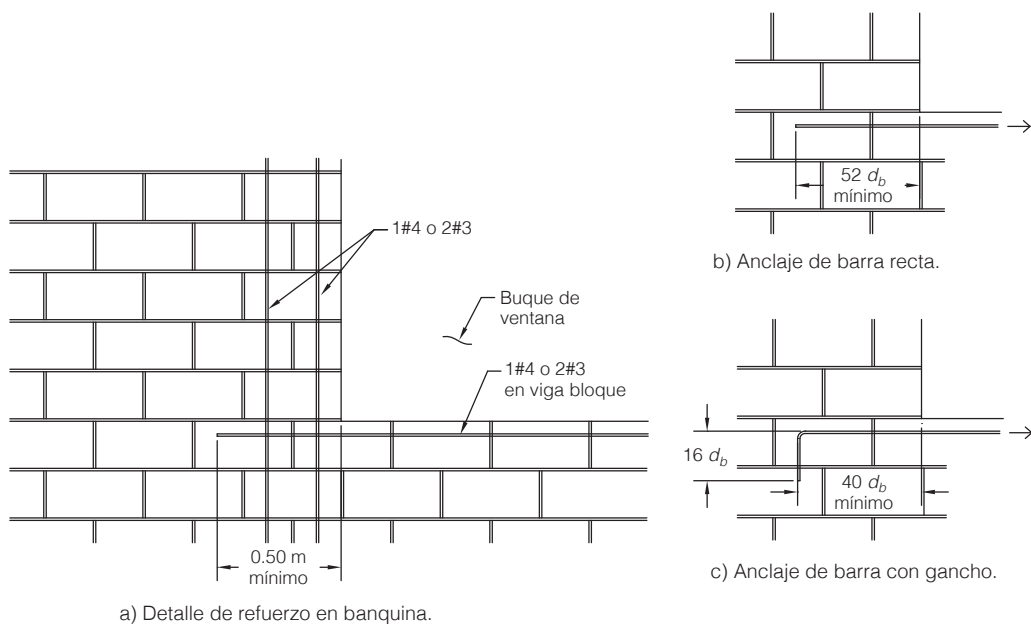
Detalles de anclaje de refuerzo en viga bloque.
